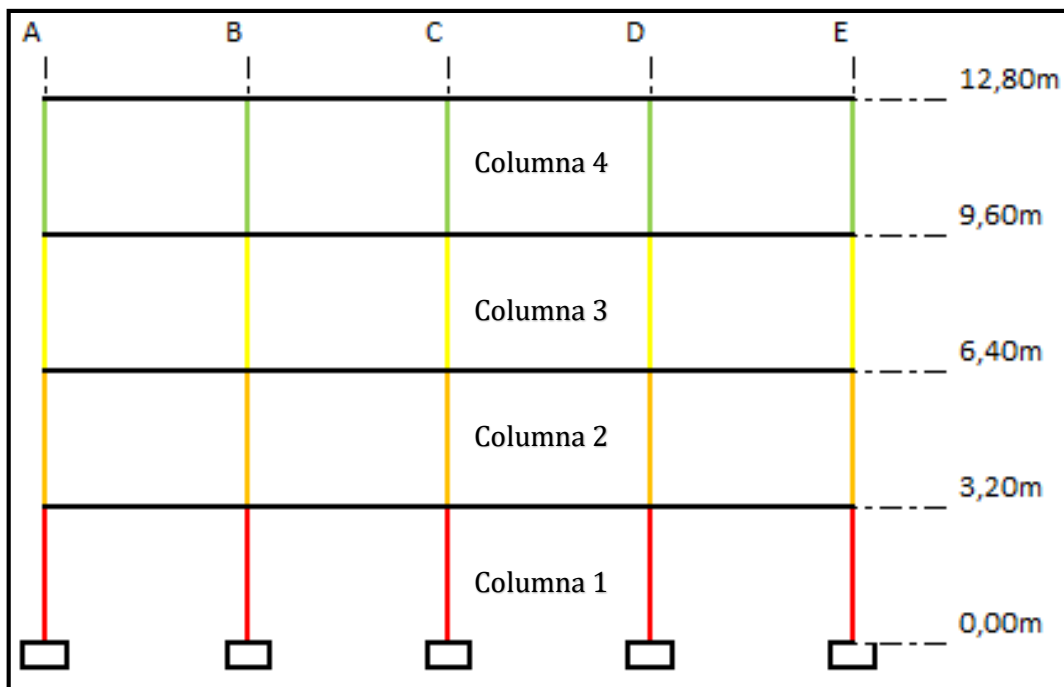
Elevación, vista de columnas con pórticos resistentes a momento.
